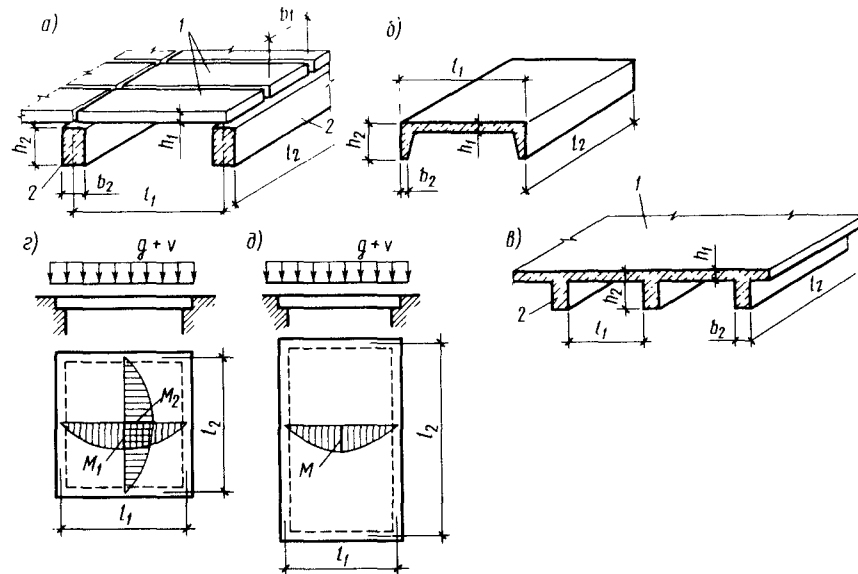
Конструкции изгибаемых железобетонных элементов:
